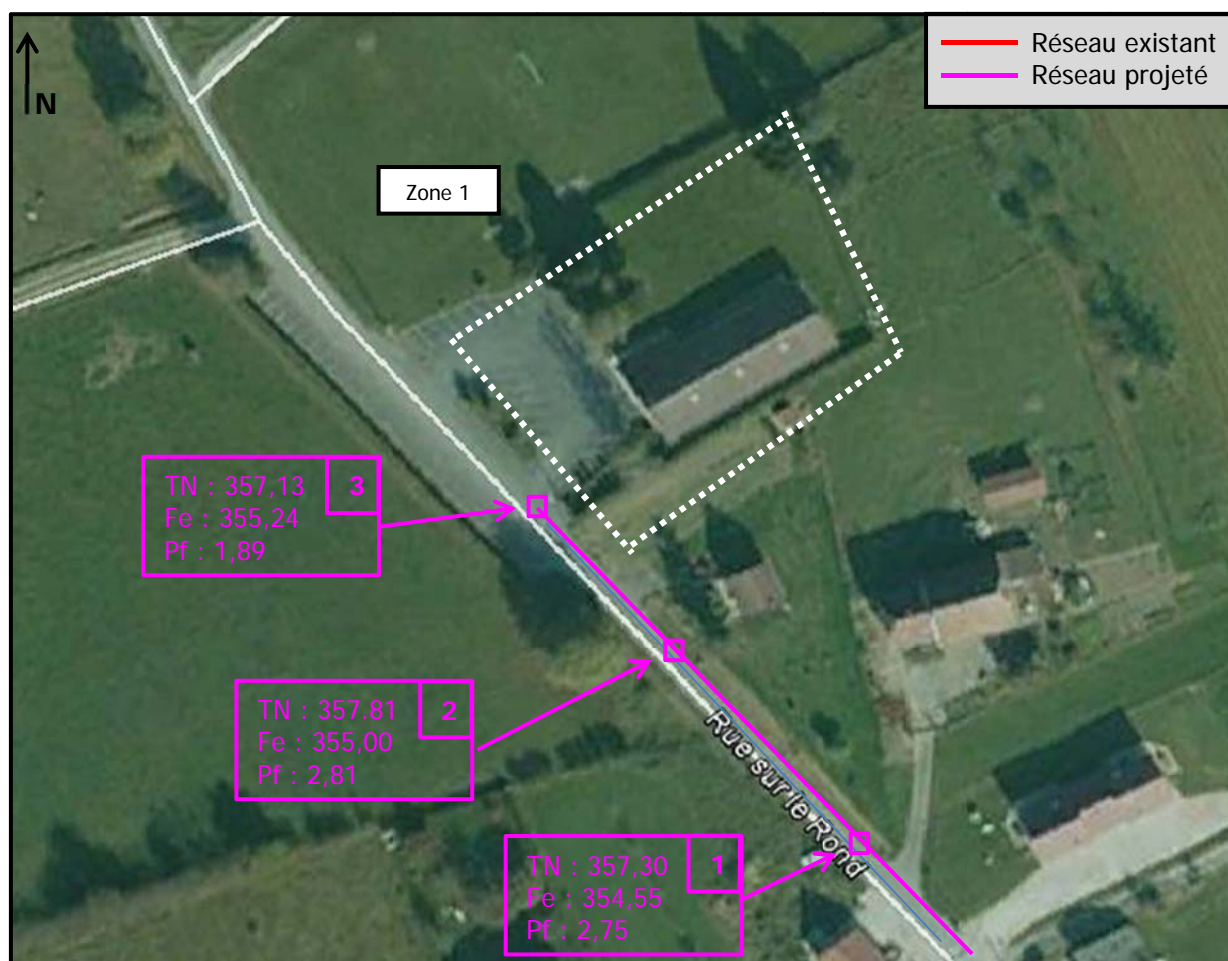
PROPOSITION TRACE DE RESEAUX ZONE 1
